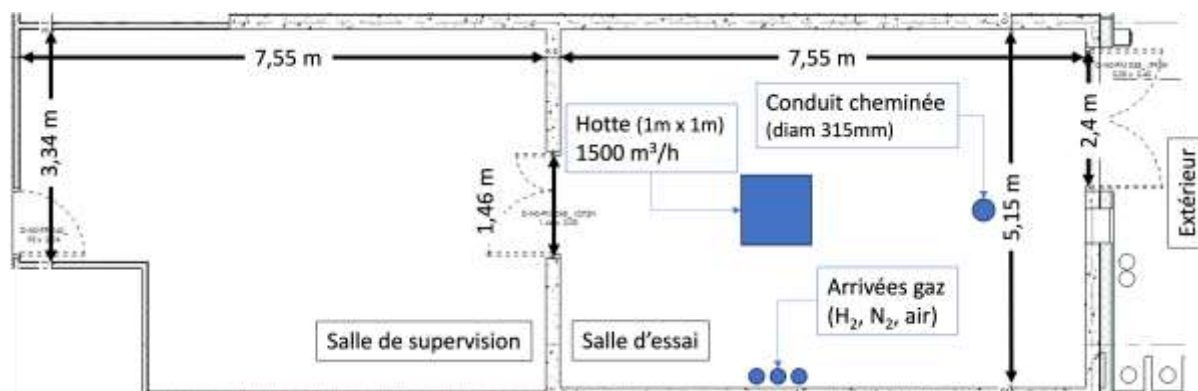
Plan simplifié de la salle d'essai avec le positionnement des principaux éléments.
